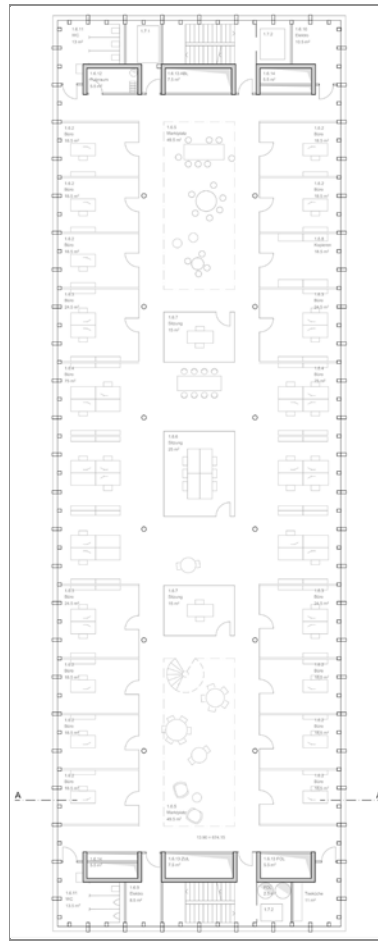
Grundriss 1. Untergeschoss
